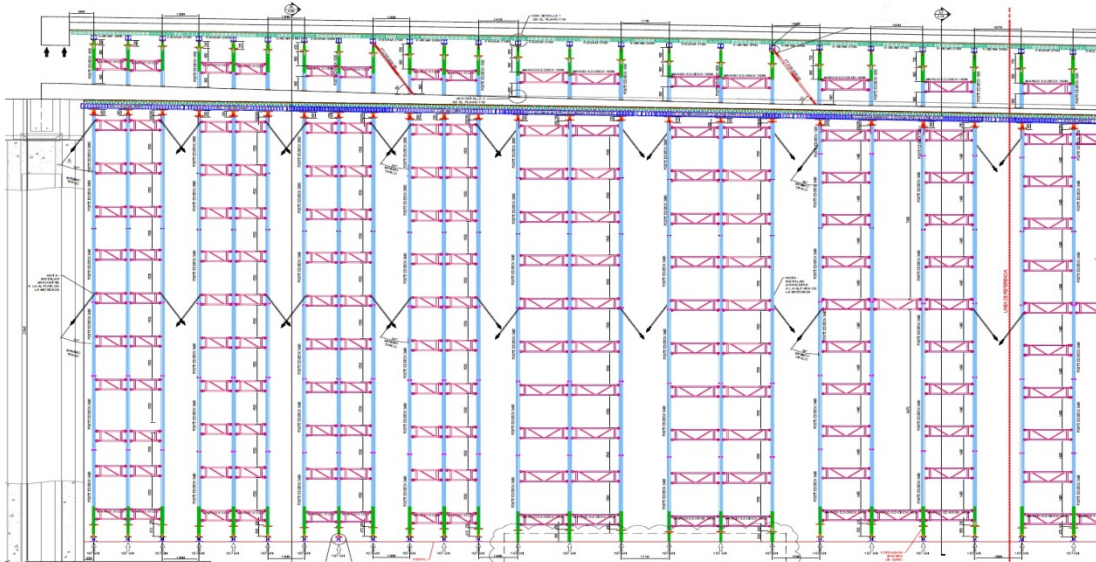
Cimbra apoyada (Vano 05 – Fuente: EFCO Puente Chilina)
